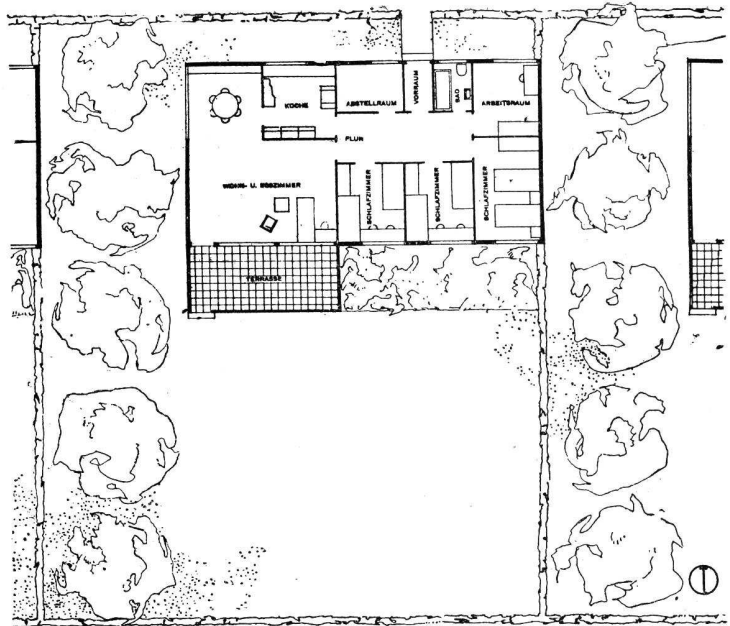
Tipo F. — Casa libremente situada (casa de planta baja) para 6 camas. Todas las habitaciones en posición Sud. 1:300. Compárese figura 13.
